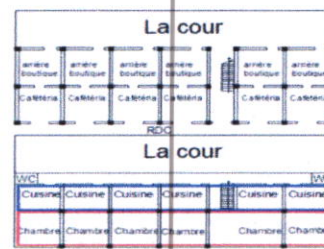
Plans du RDC et du 1er étage Source : Archive d'Hussein dey
